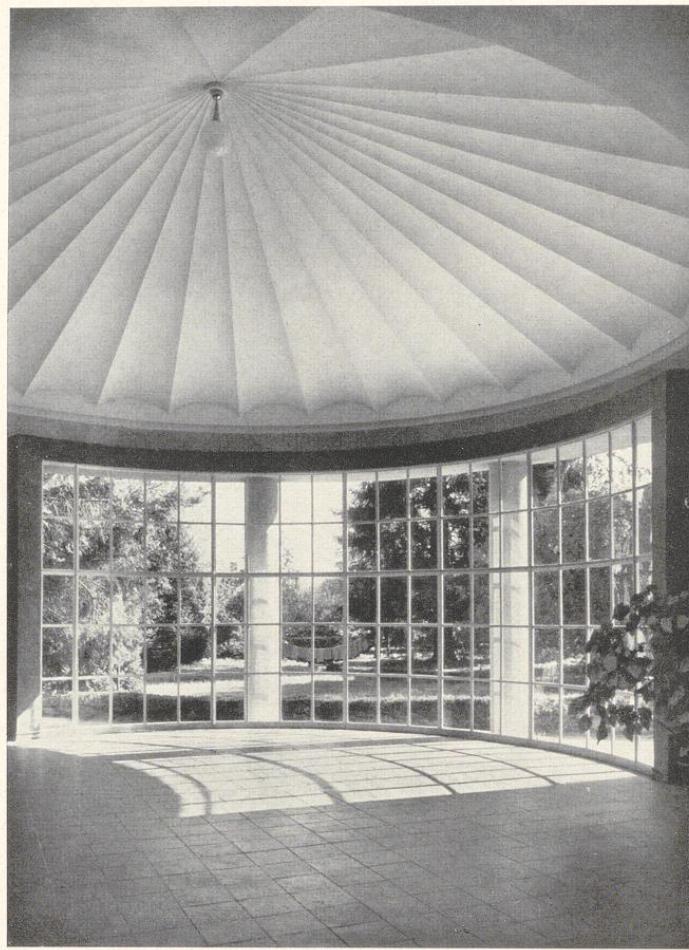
Schirmgewölbe über der Wandelhalle der Landeskuranstalt Bad Hall.
